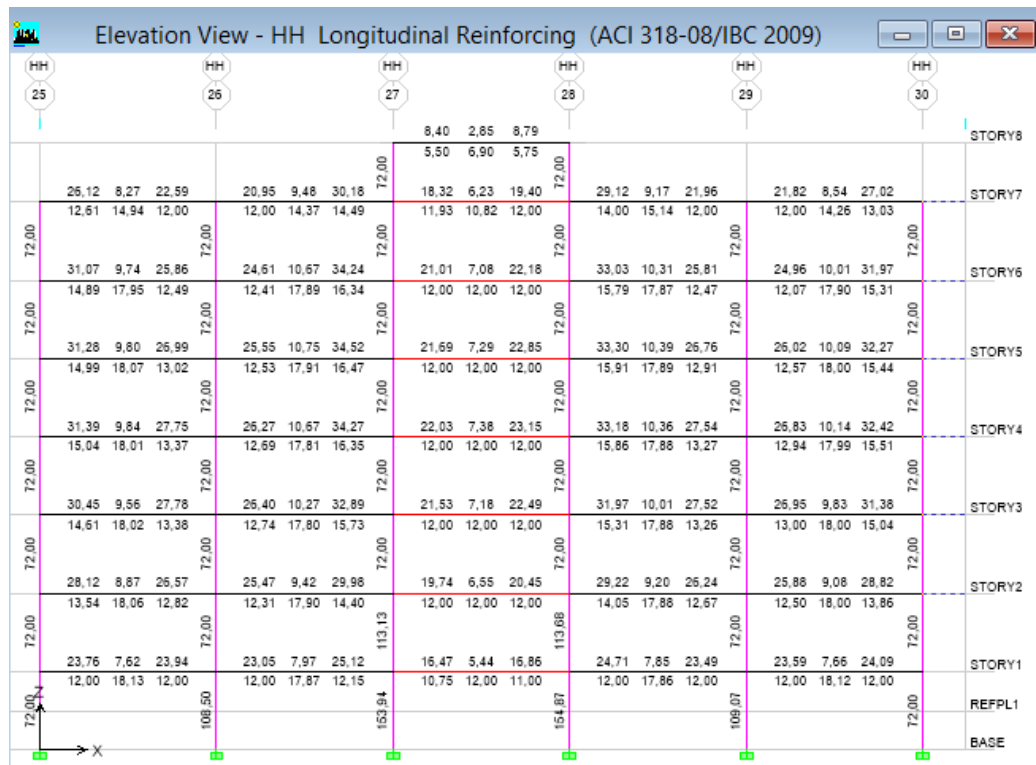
Acero en Vigas y Columnas en el Pórtico HH – Hospitalización 2- (CEC-2002)
